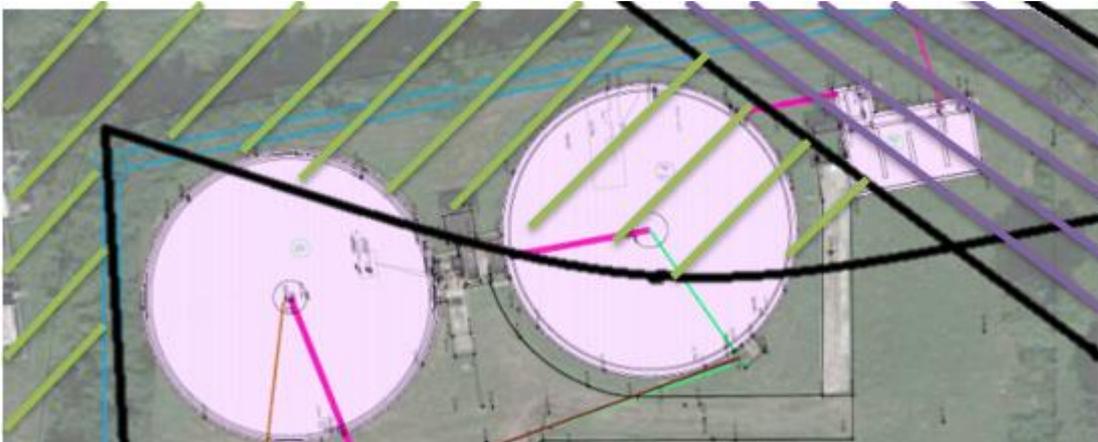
sovrapposizione tra planimetria SdF e vincoli paesaggistici (in verde fascia fluviale e in viola fascia di rispetto forestale)
